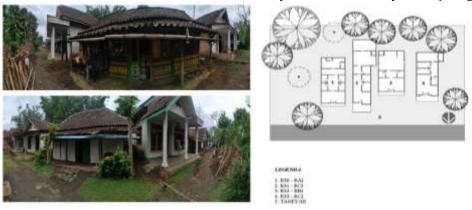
Foto Kondisi Area (kiri) dan Gambar Layout (kanan) Taneyan Lanjhang 4 (T4)
